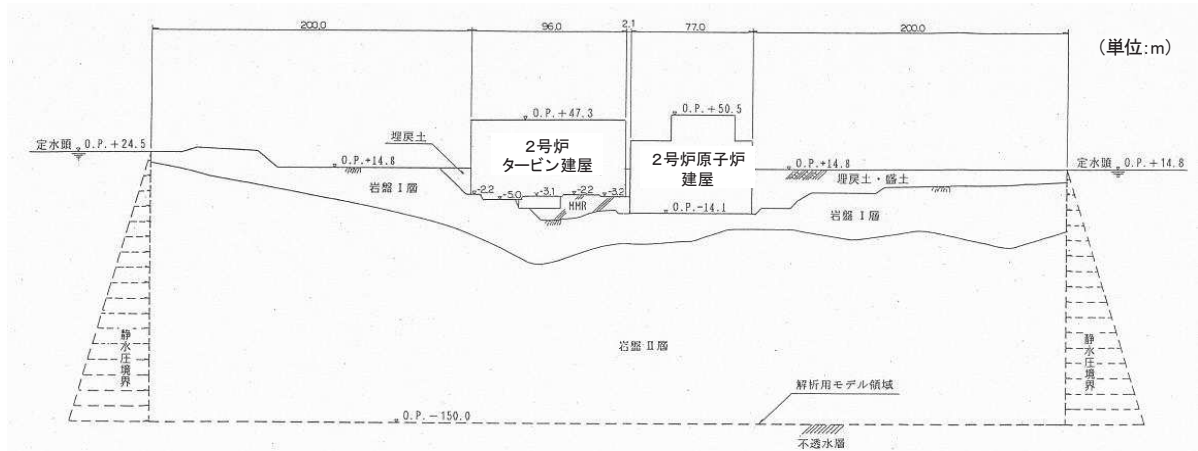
浸透流解析断面図 (A-A' 断面)
